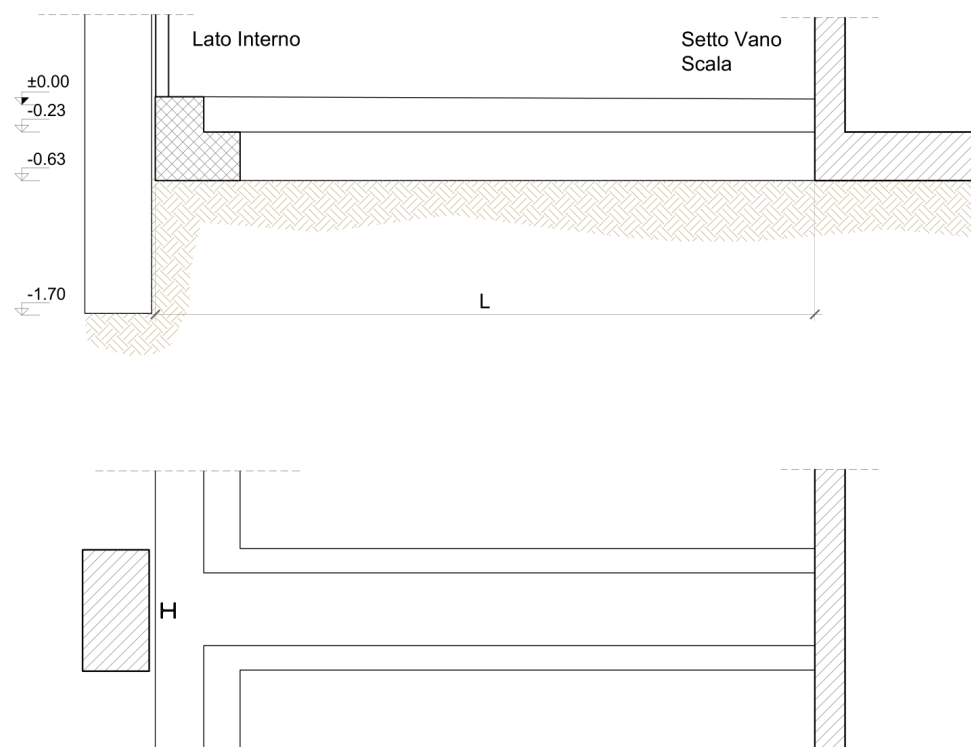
Trave rovescia di fondazione e connessione al setto del nuovo vano scale.
